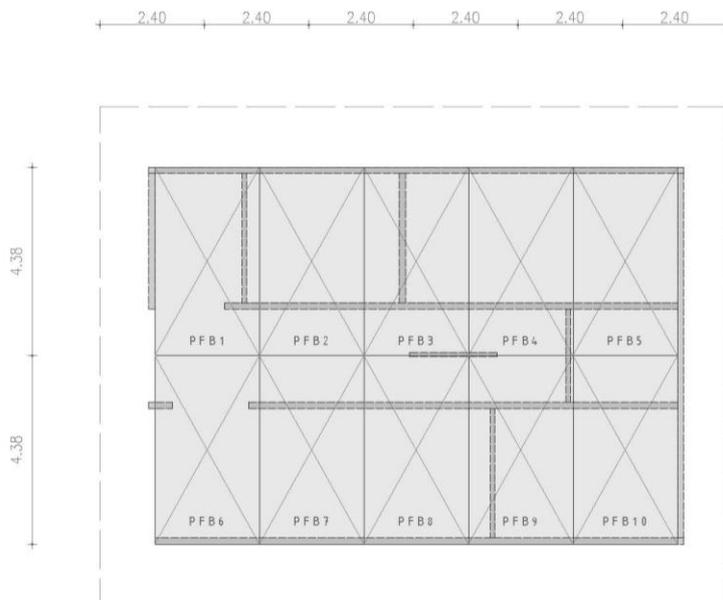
despiece panel CLT del forjado de techo planta baja.
